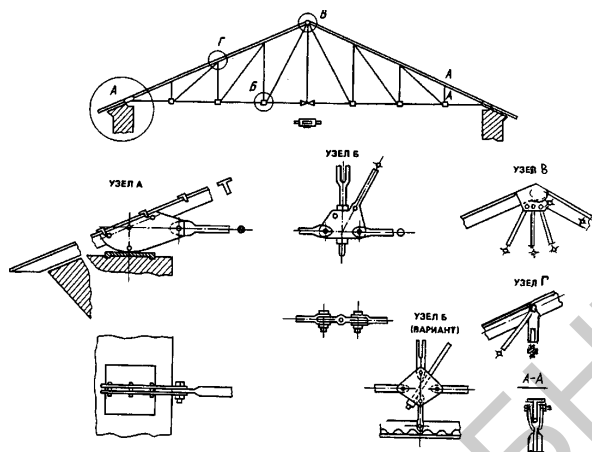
Стропильная ферма (70-е годы XIX века)
